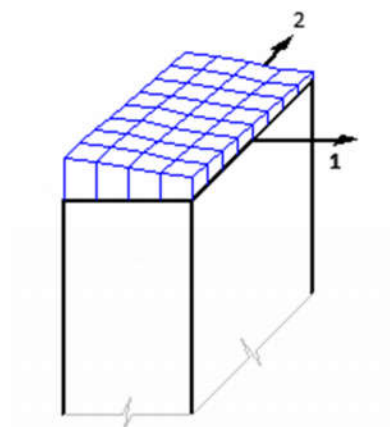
Seção Transversal genérica discretizada em elementos de área
